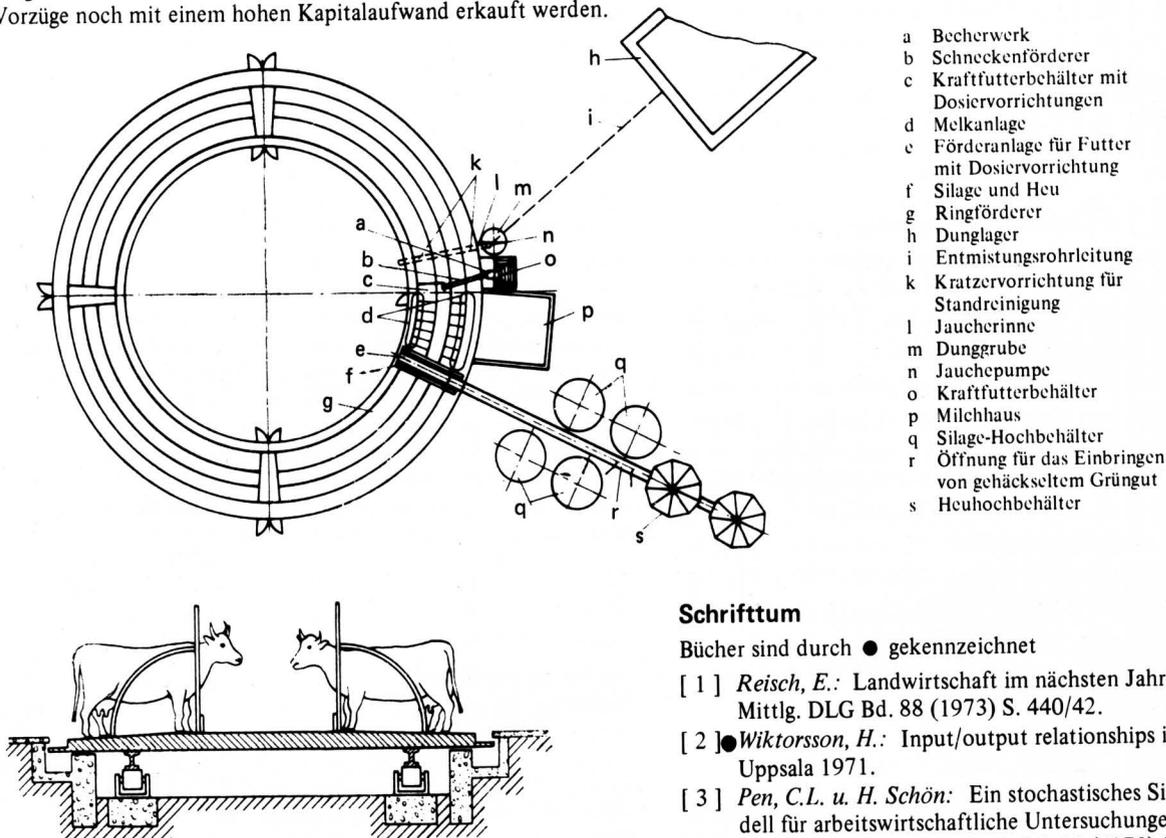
Grundriß einer Stallanlage für die Haltung von Milchvieh mit Palettenförderung.
